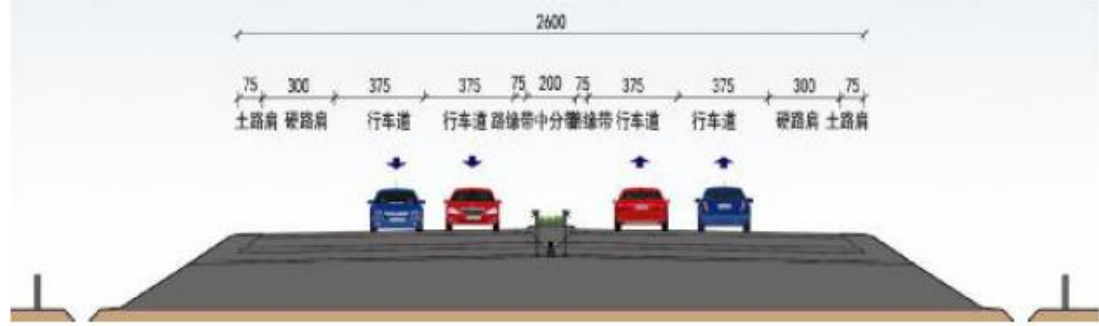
新业路（G204~开放大道段）现状道路标准横断面图
